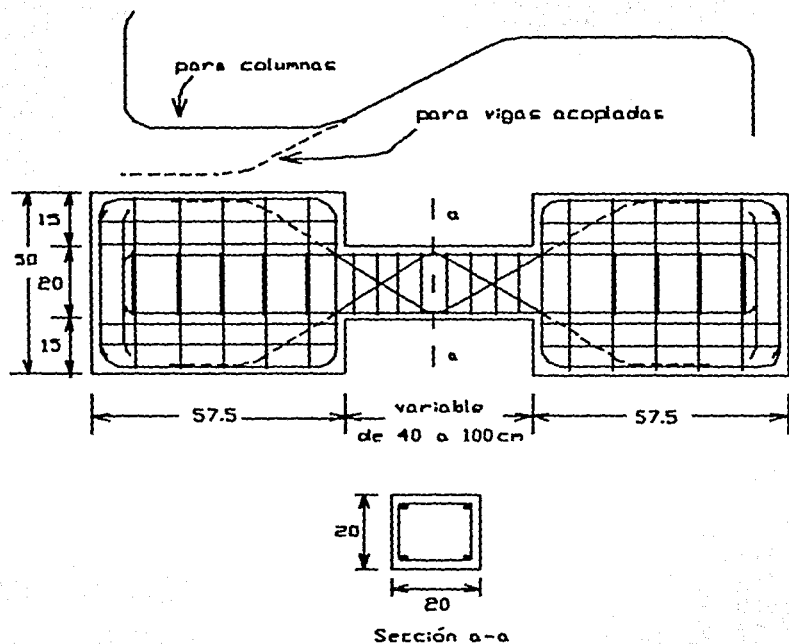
Espécimen típico con refuerzo rómbico.
